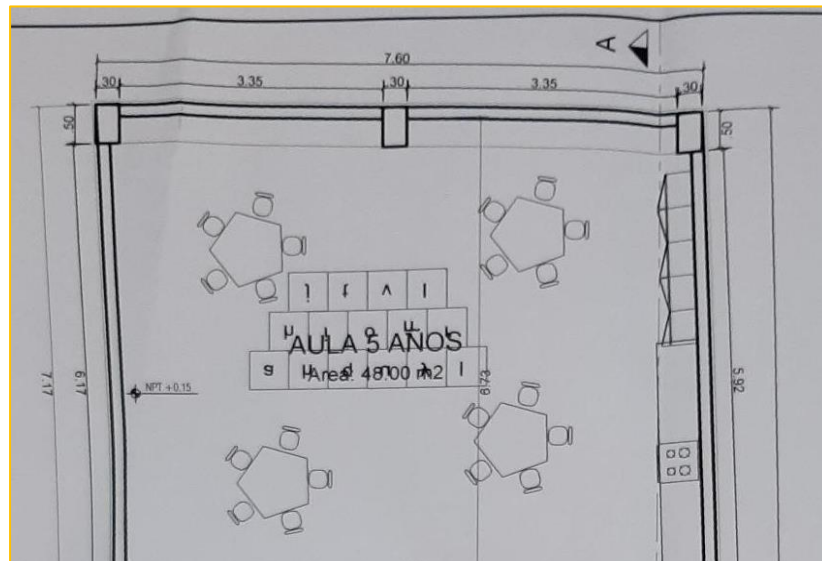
Plano de arquitectura, ambiente aula de 5 años.
